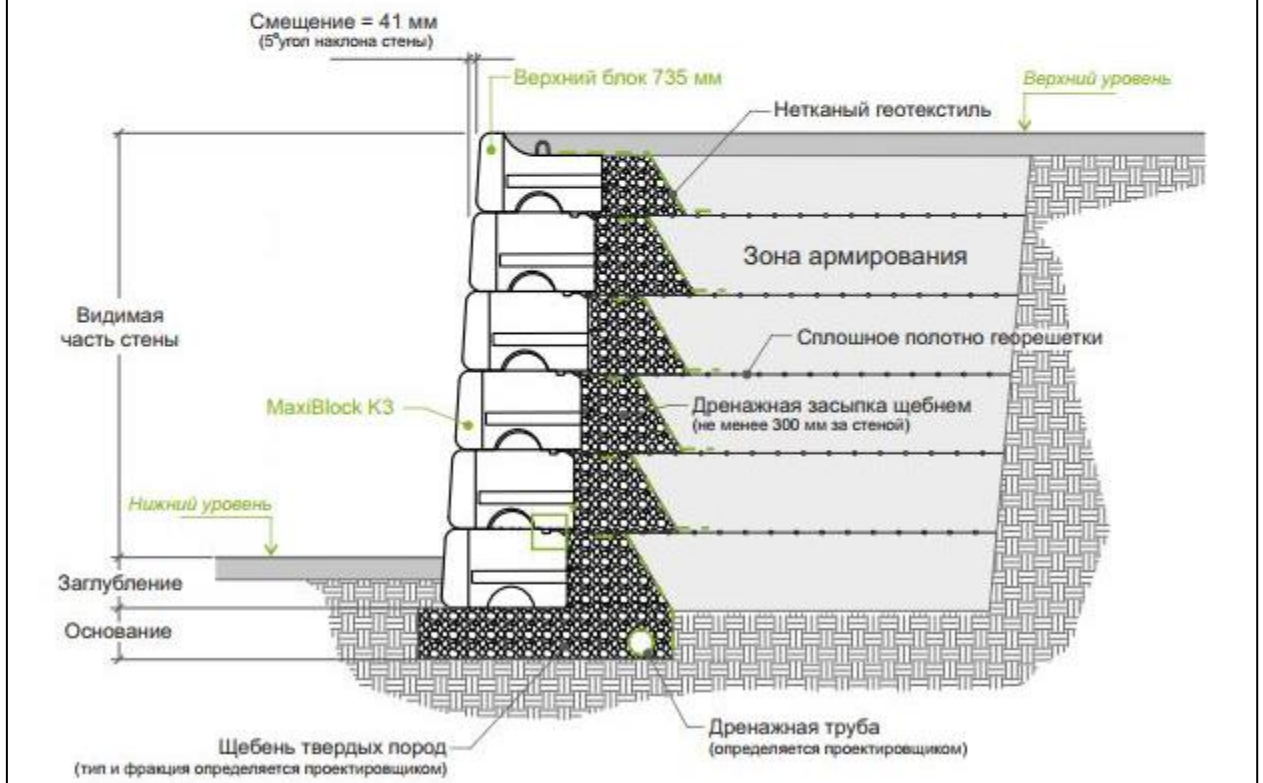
Типовий перетин армогрунтової підпорної стіни з кутом нахилу 5°
